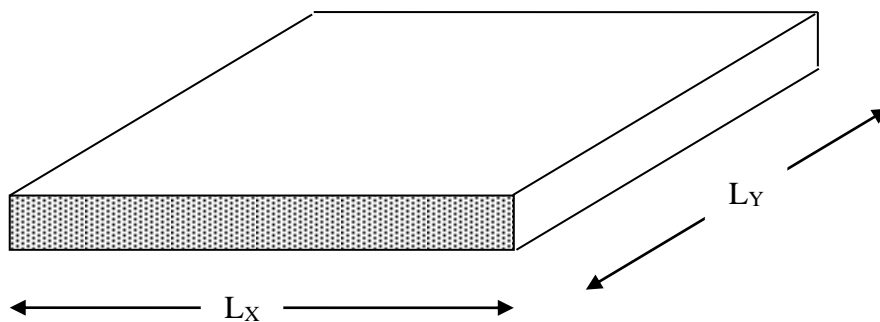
vue en plan des dimensions du panneau le plus sollicité
